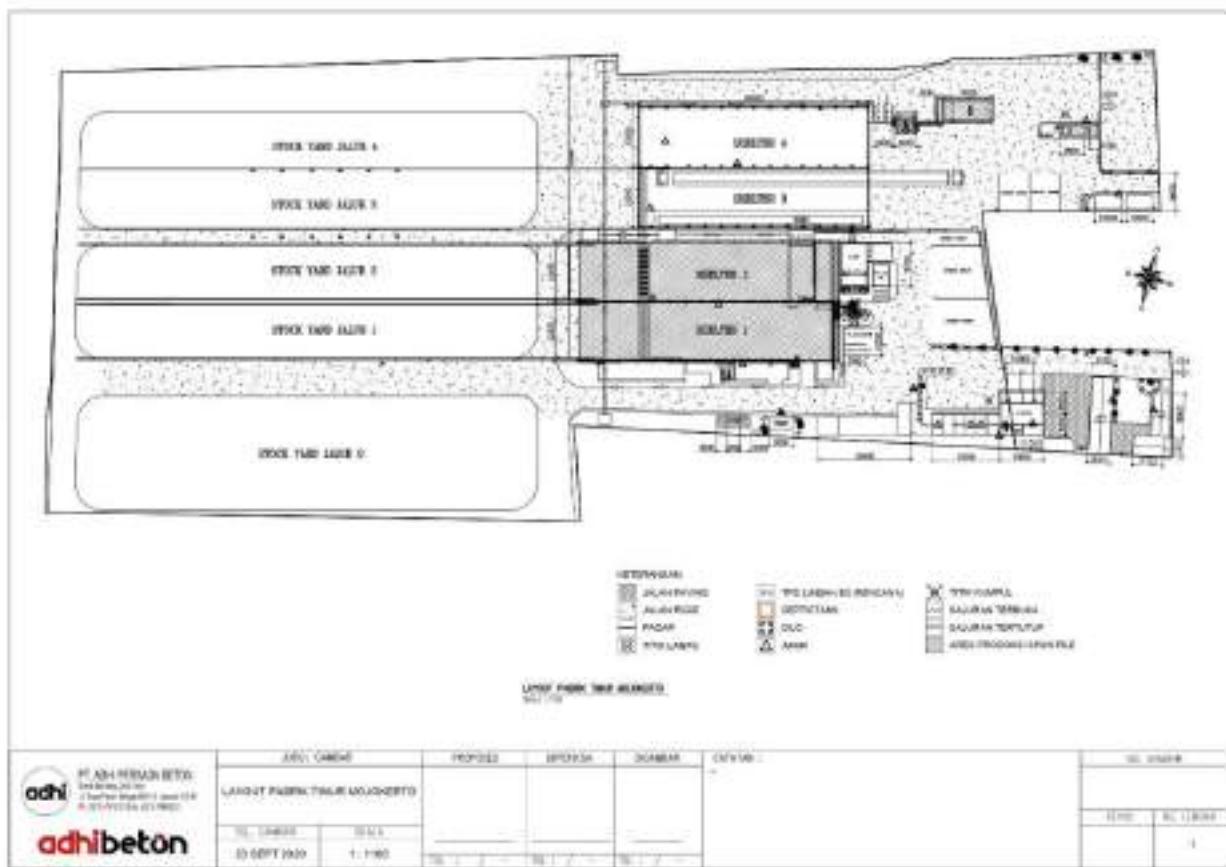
Pabrik Timur PT. Adhi Persada Beton
